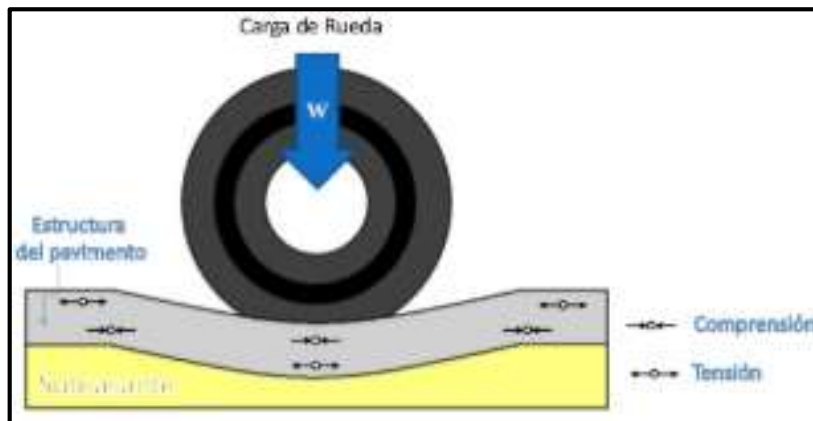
Esquema de esfuerzos por aplicación de cargas sobre pavimento
